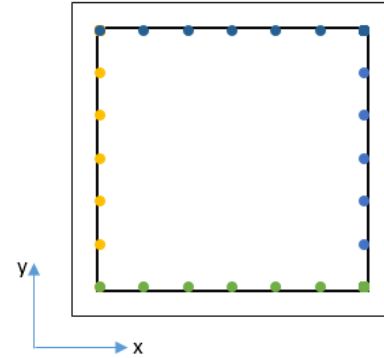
Comprobación de la cuantía en la columna tipo C-2 de sección 0.95 m*0.95 m
